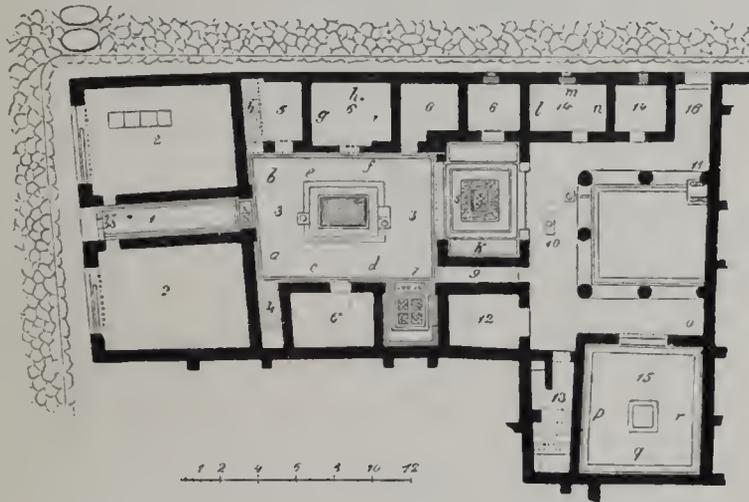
Casa del Poëta. Grundriß. (Nach Overbeck.)
